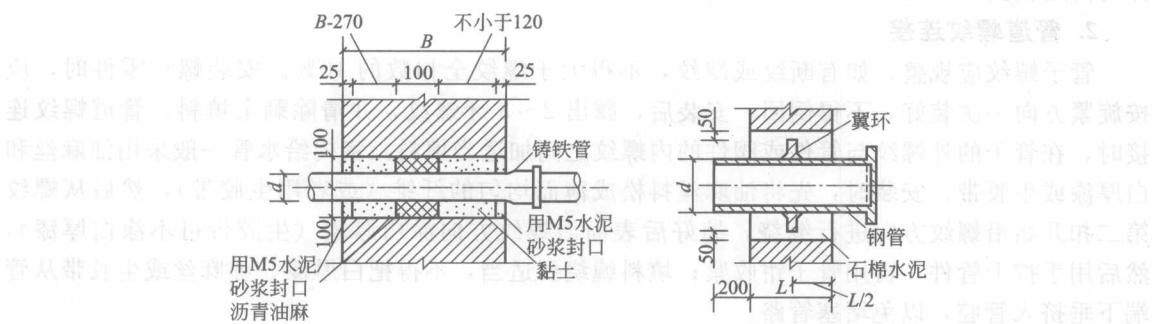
引入管穿过带形基础剖面图 (单位: mm)
